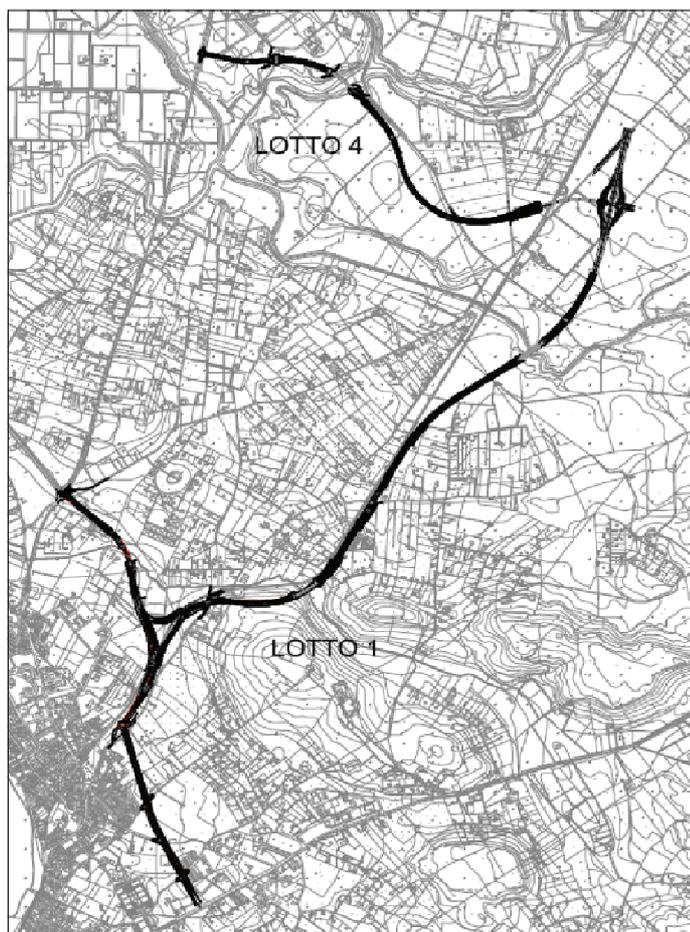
Assetto finale Lotto 1 e Lotto 4
